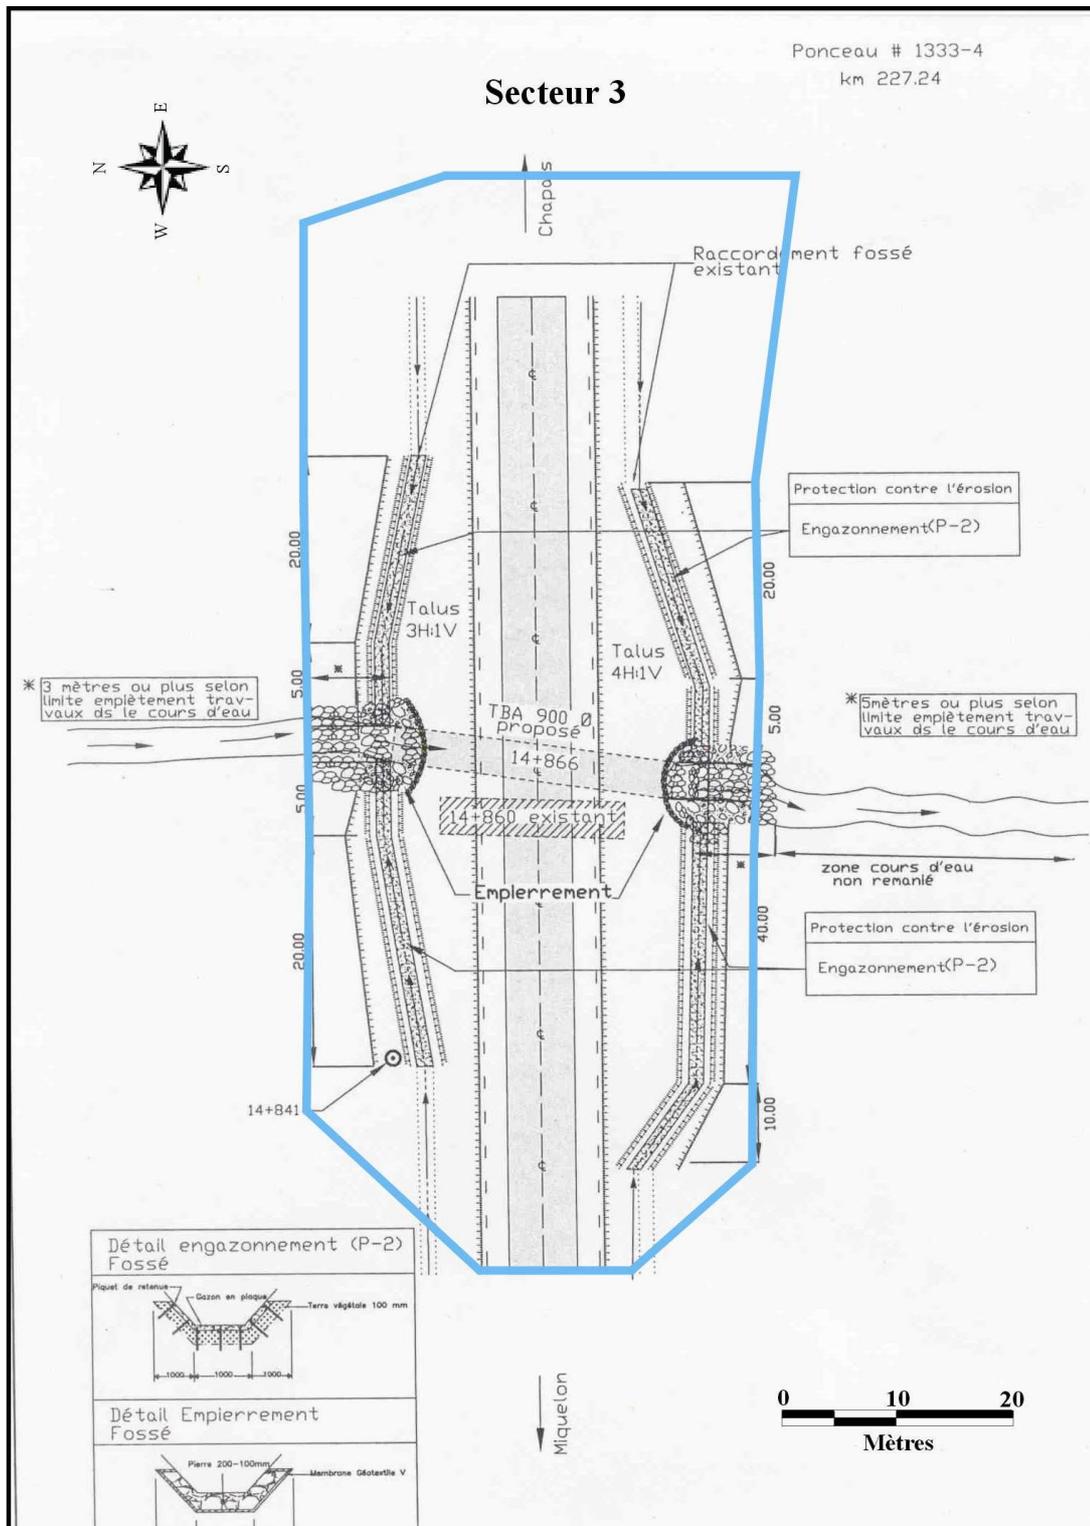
projet 154-07-0858, ponceau #1333-4, plan de construction et secteur d'inventaire.
